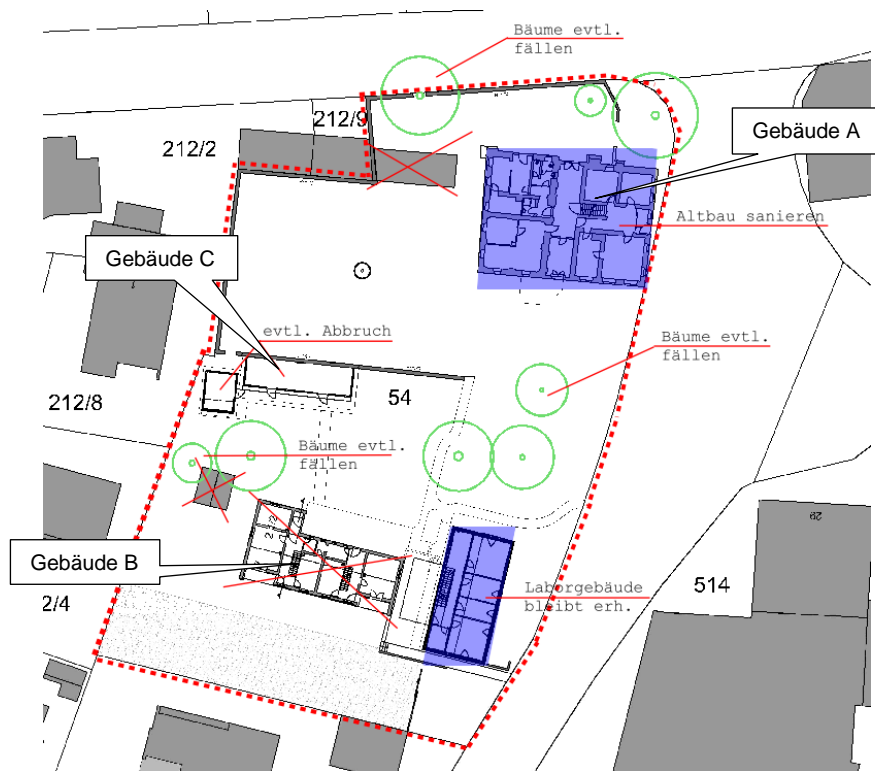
Planskizze und Darstellung der geplanten Maßnahmen.
